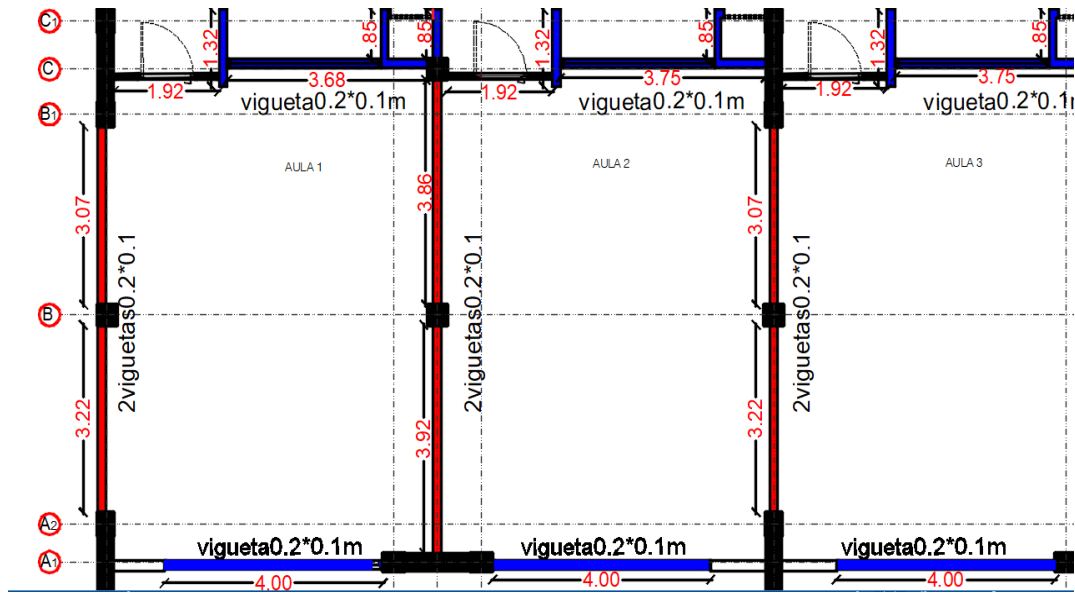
Zoom viguetas AUTOCAD – fuente propia
